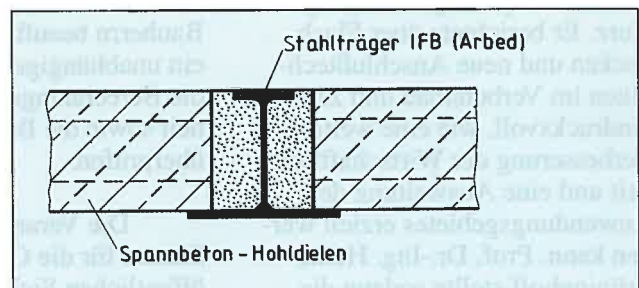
Stahl-Flachdecken mit Spannbetonhohldielen
